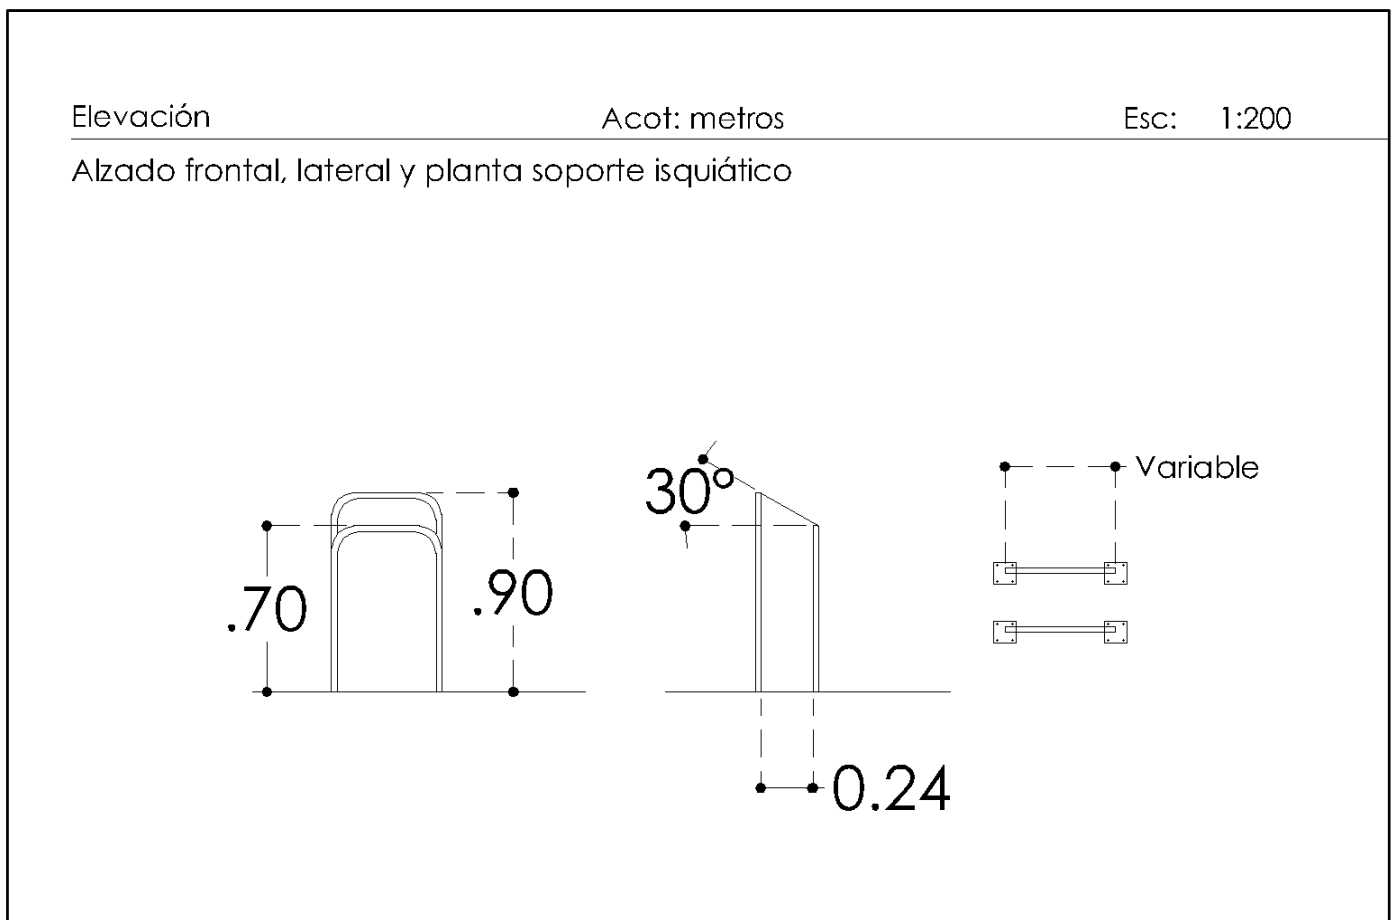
Vista frontal, lateral y planta de soporte isquiático (Elaboración propia IMEPLAN, 2020)
